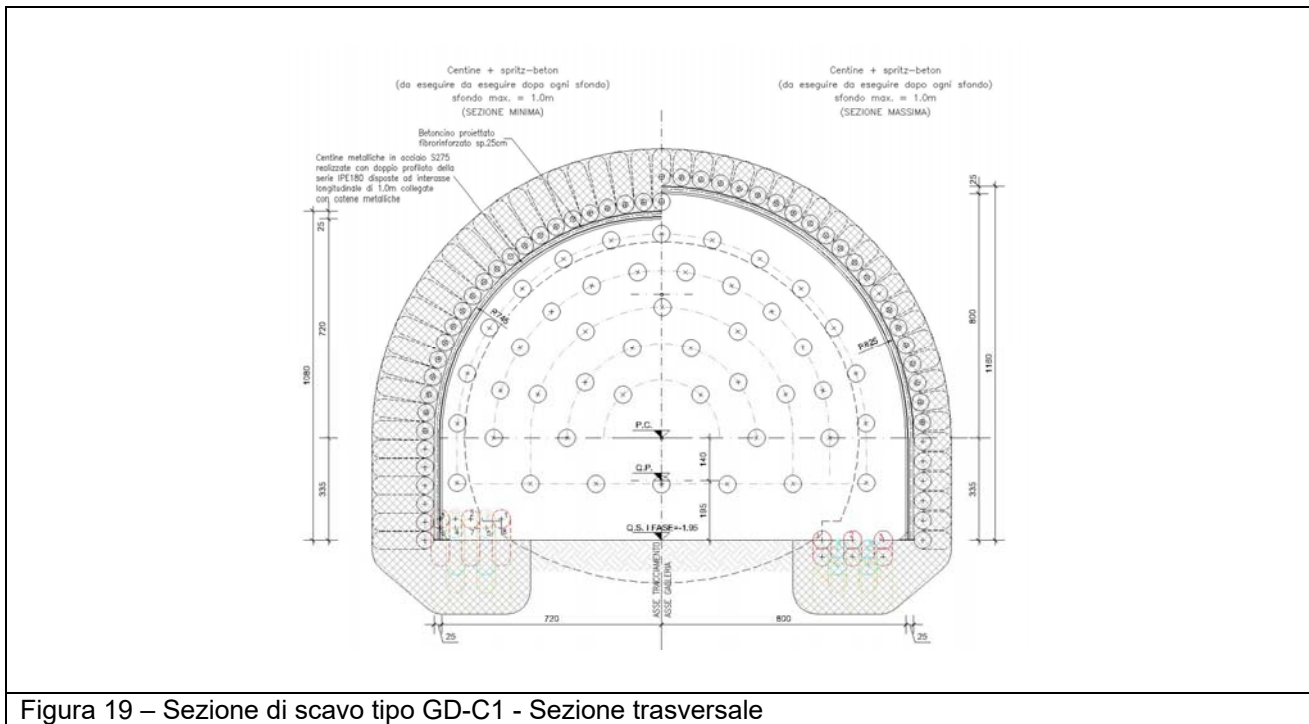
Sezione di scavo tipo GD-C1 - Sezione trasversale
